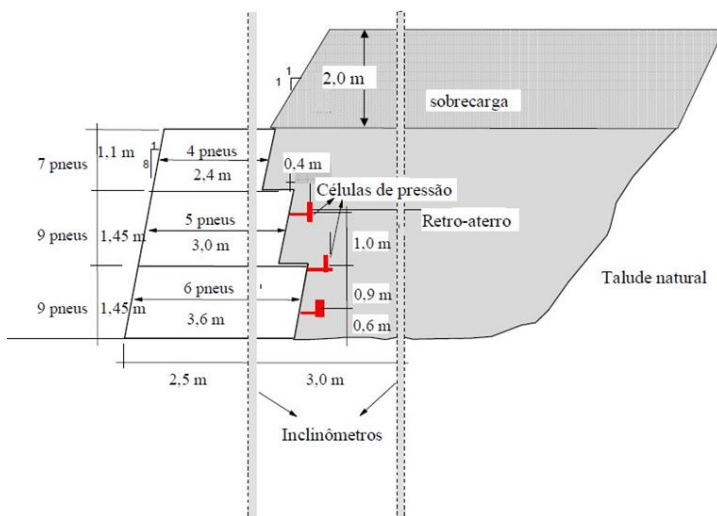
Seção transversal típica do muro experimental (Medeiros et al., 2000).
